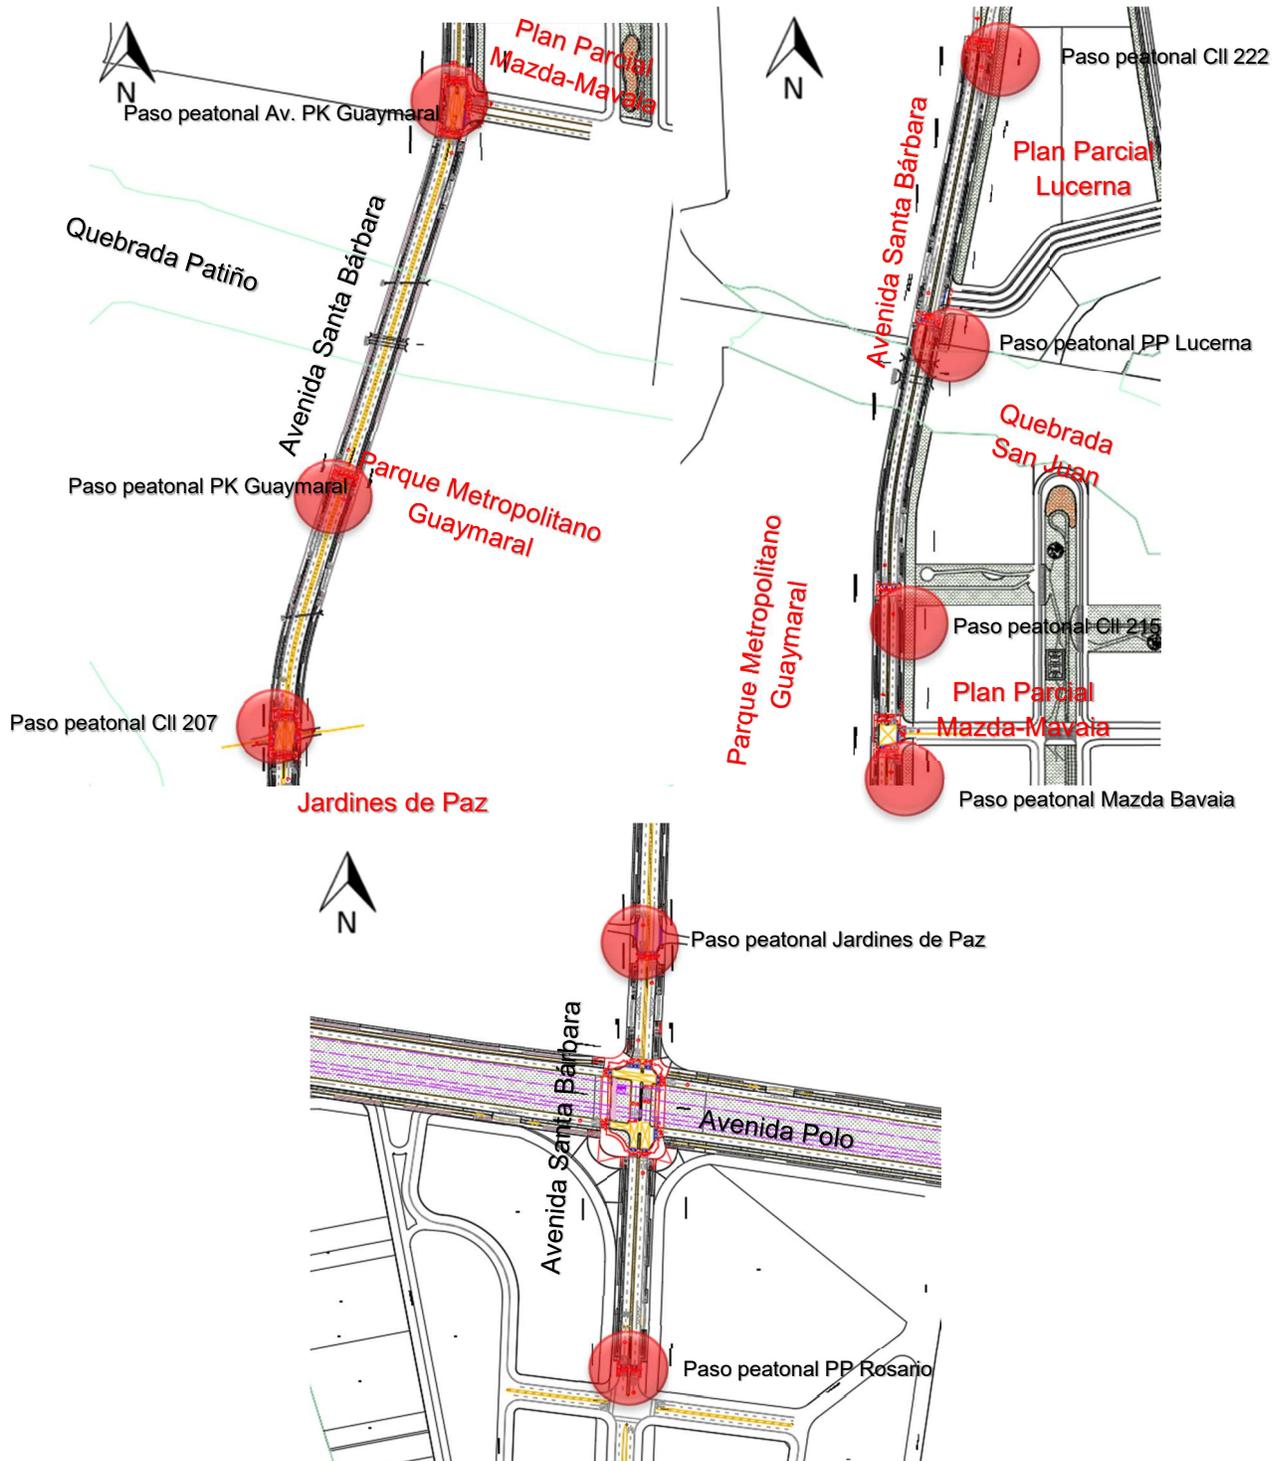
Localización de las intersecciones Avenida Santa Bárbara
